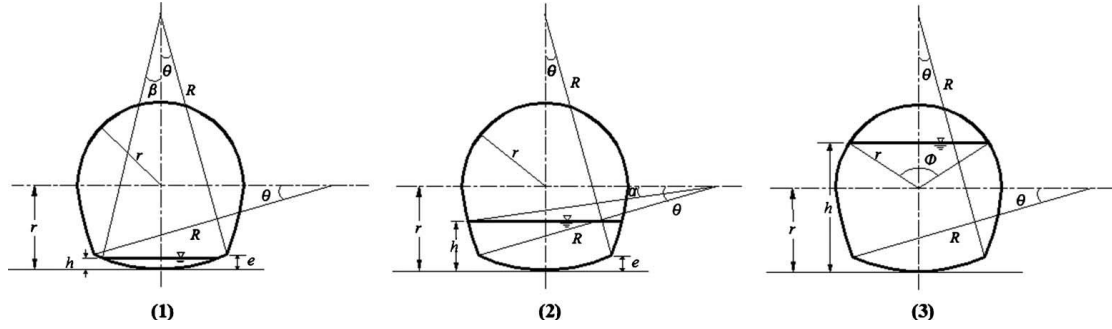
Coupes des sections du tunnel fer à cheval type I.
